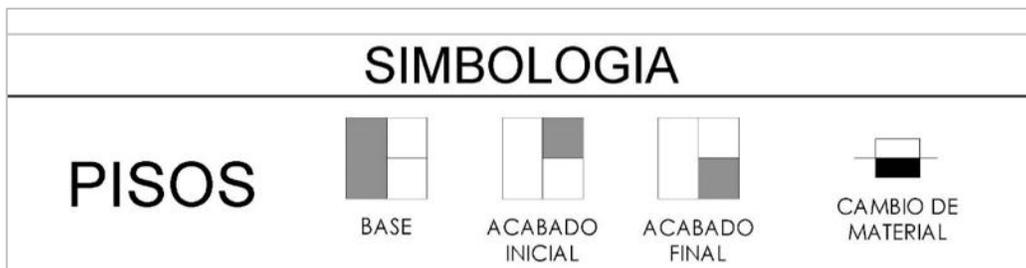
Simbología utilizada en la planimetría de materiales y sistemas constructivos. Elaborada por Aldo Zamudio Pérez
